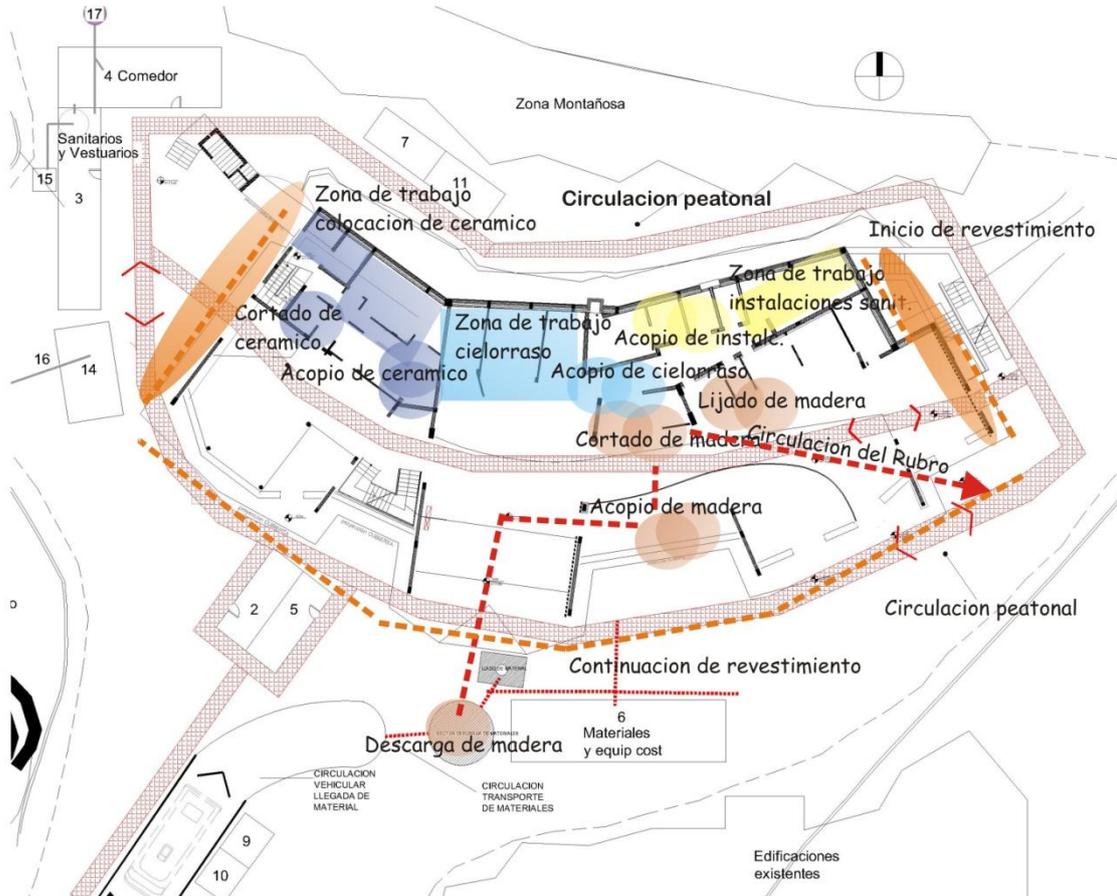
Zonas de trabajo por Rubro en Planta Baja de la Obra.
